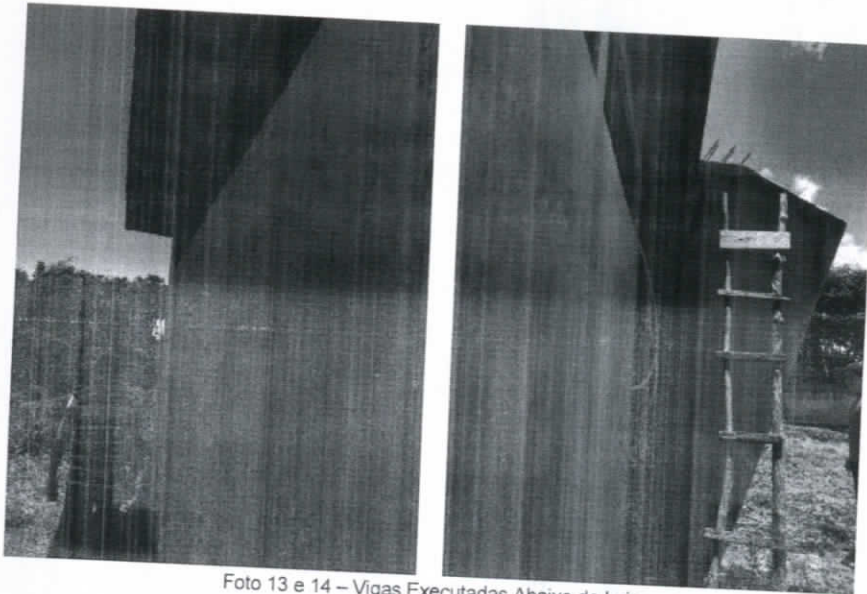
e 14 – Vigas Executadas Abaixo da Laje
